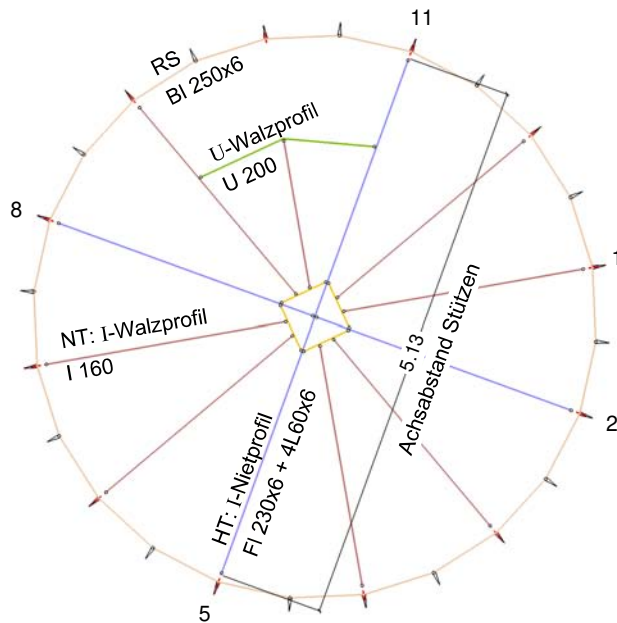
Grundriss Decke über Schlafräum mit Querschnittsbezeichnungen
